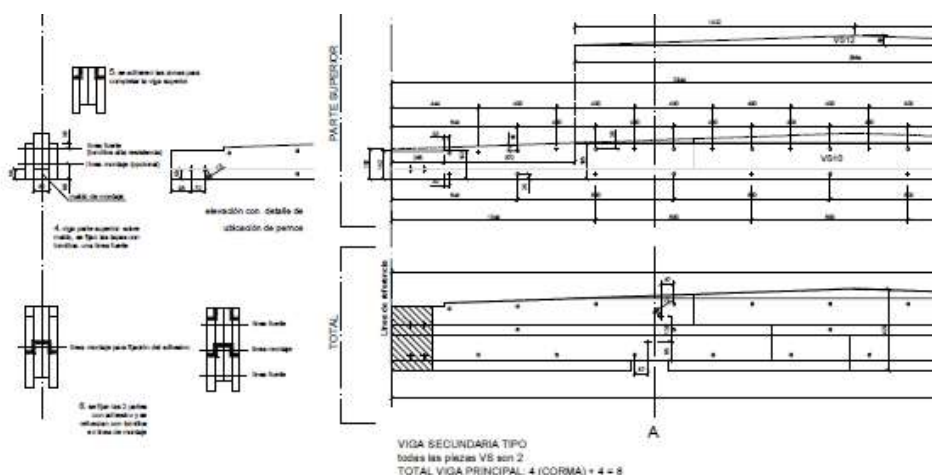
Fragmento de un plano de montaje de una viga secundaria.
